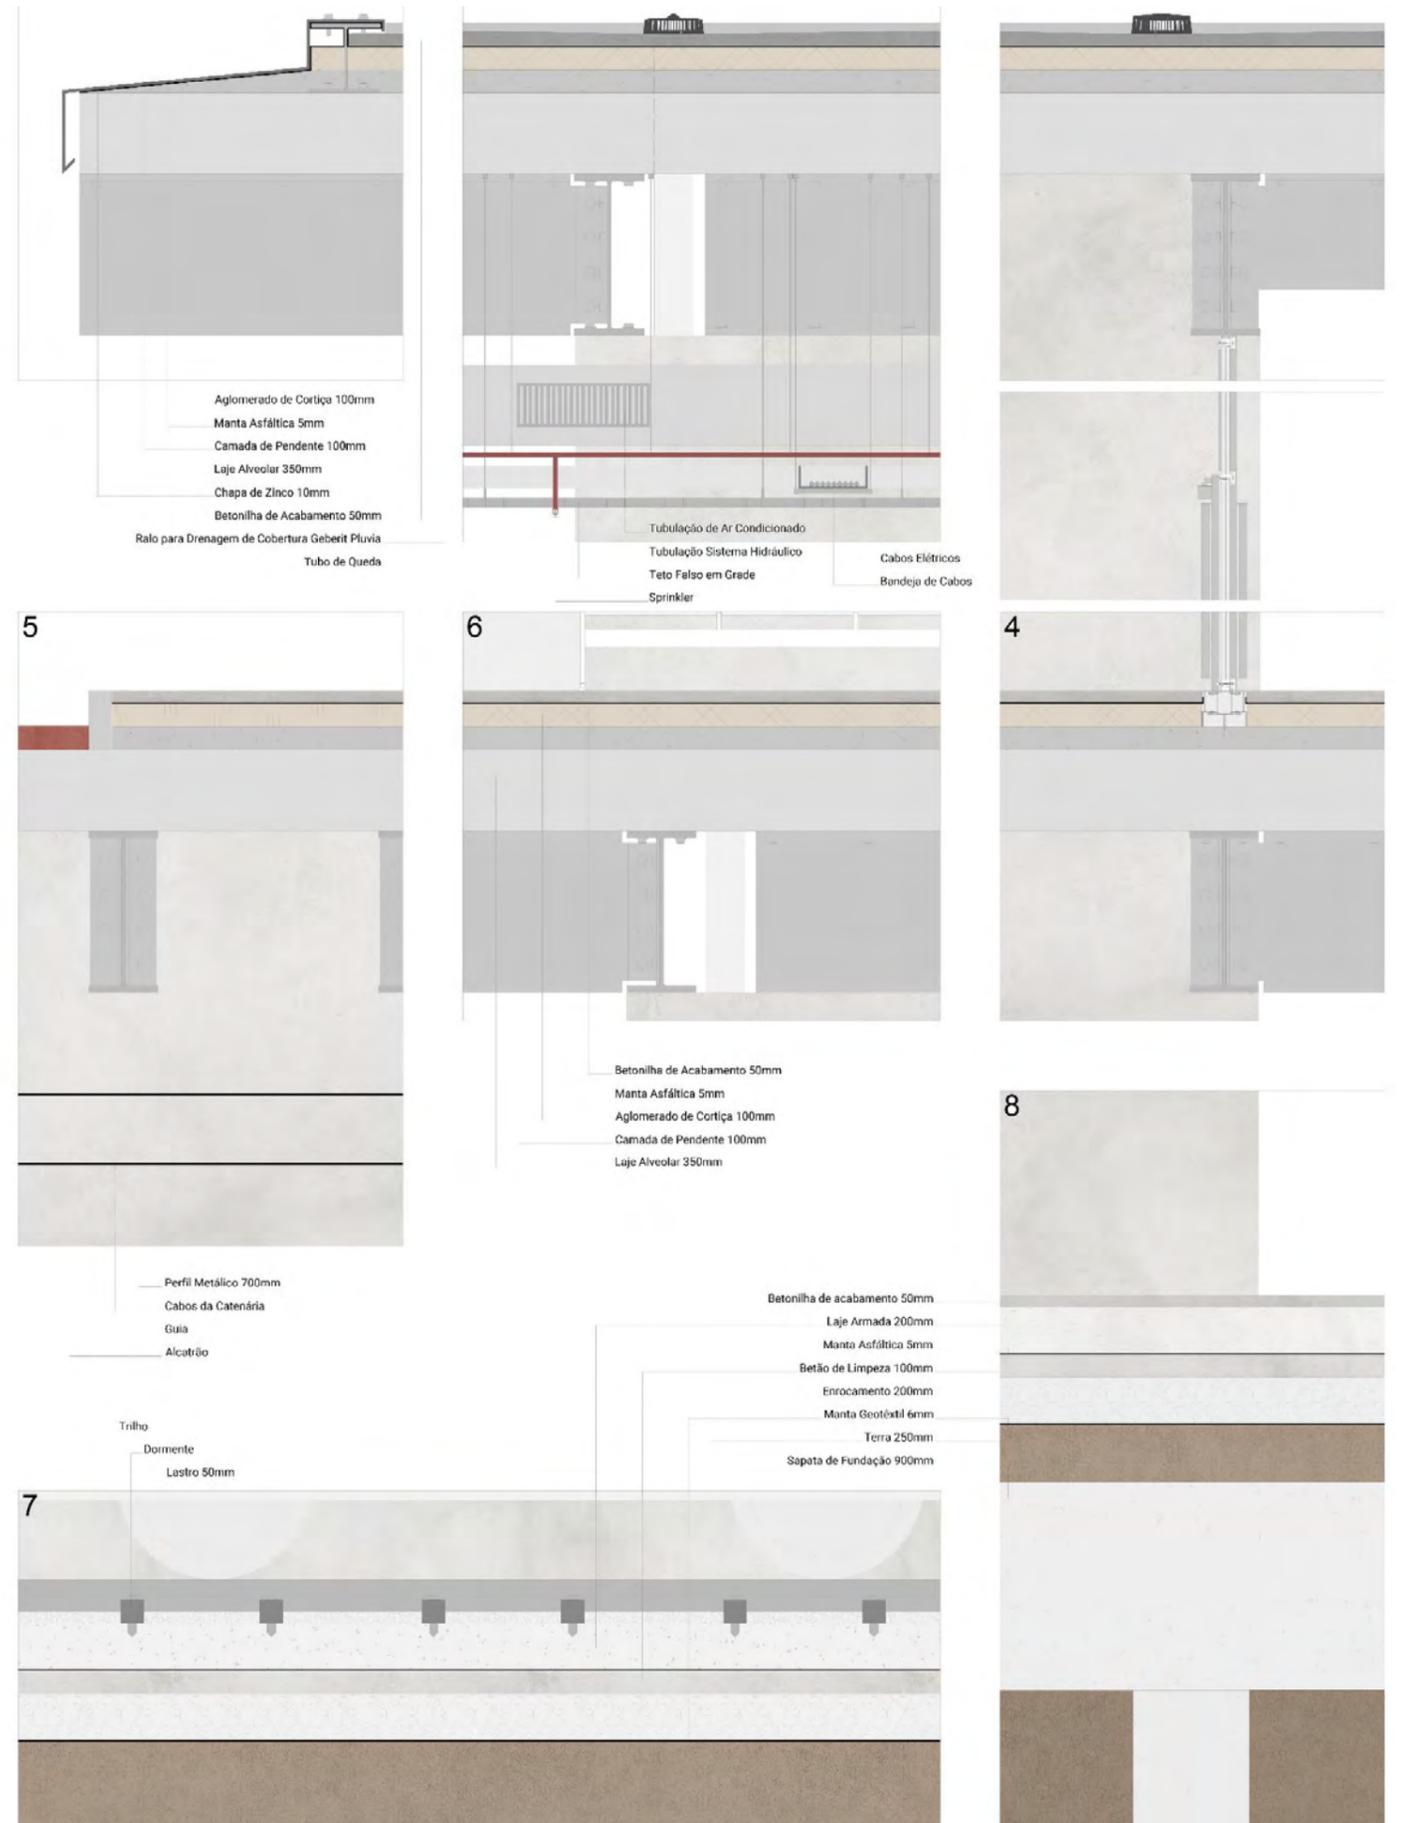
Planta e corte da Estação Ferroviária com detalhe construtivo.
